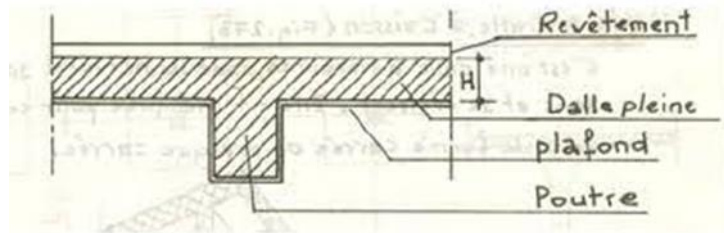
Coupe verticale d'un plancher dalle pleine
